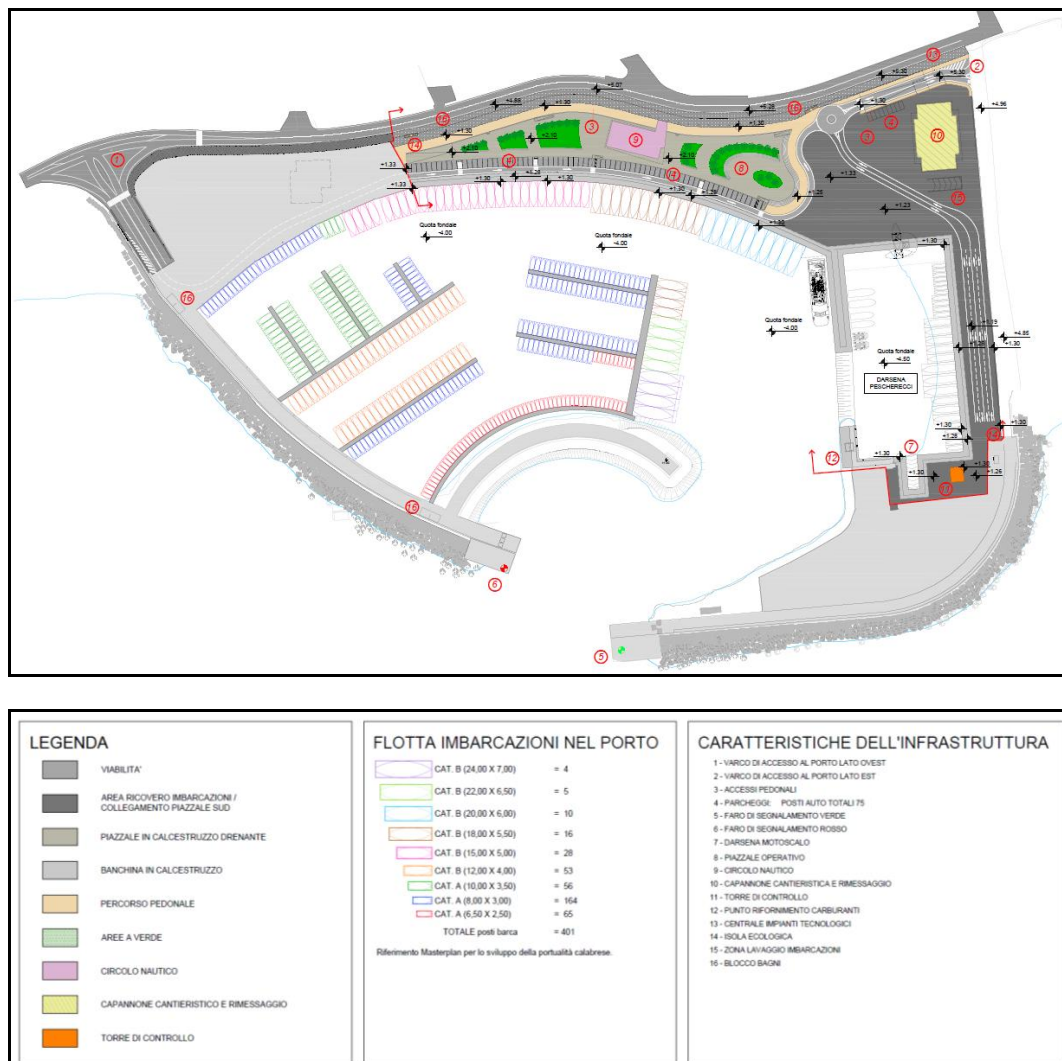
Porto di Catanzaro Lido, planimetria generale di progetto
